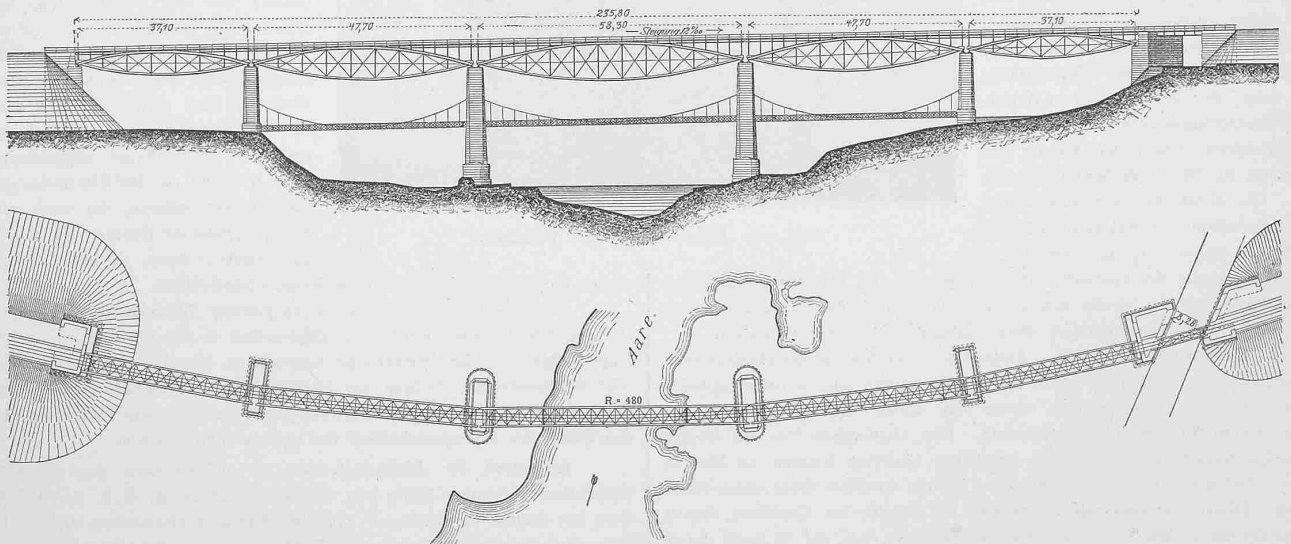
Die Eisenbahnbrücke bei Brugg, erbaut 1873—1875. — Ansicht und Grundriss. — Masstab 1:1500.
